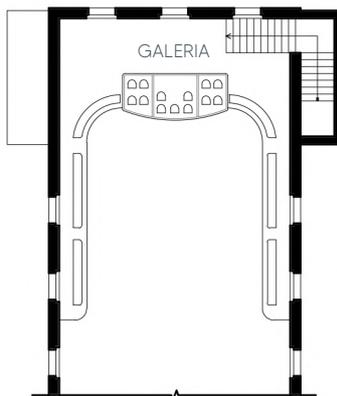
redesenho da planta da galeria do pavilhão de ginástica.
